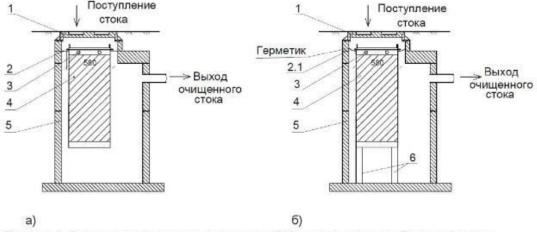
Схема установки фильтр-патрон ø580мм под люком на бетонной плите перекрытия колодца
